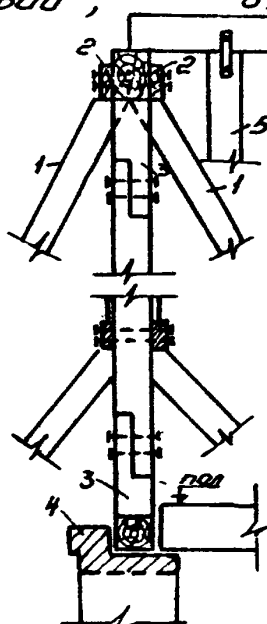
Угловые сопряжения рам каркаса наружных стен:
